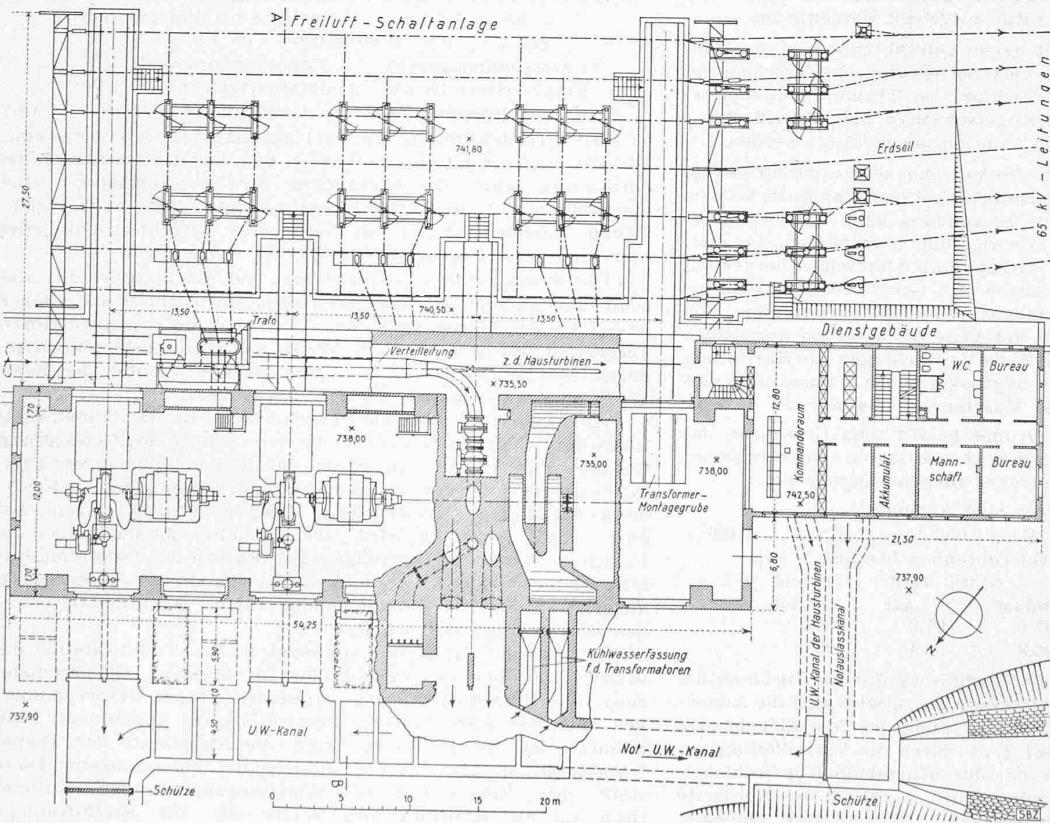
Die Zentrale Mörel mit der Freiluft-Schaltanlage der Rhonewerke A. G. Ernen Grundriss (mit Horizontalschnitt in Kote etwa 737) 1: 300
